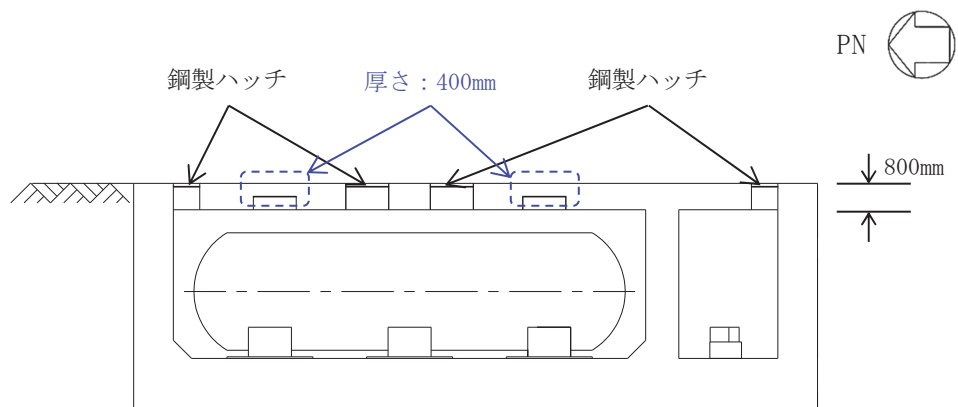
軽油タンク室の概略断面図 (A-A' 断面)
